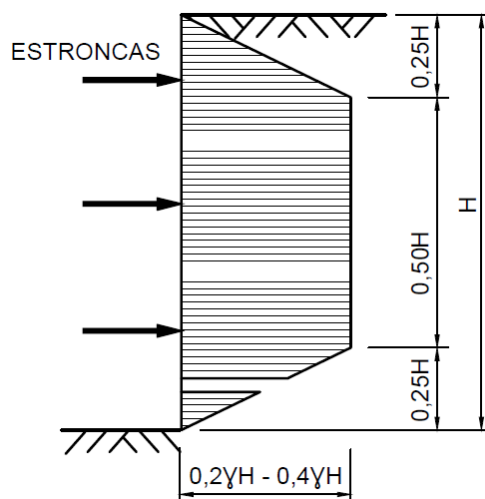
Diagrama de pressões aparentes para argilas rijas e fissuradas (Adaptado de Terzaghi e Peck, 1967).
